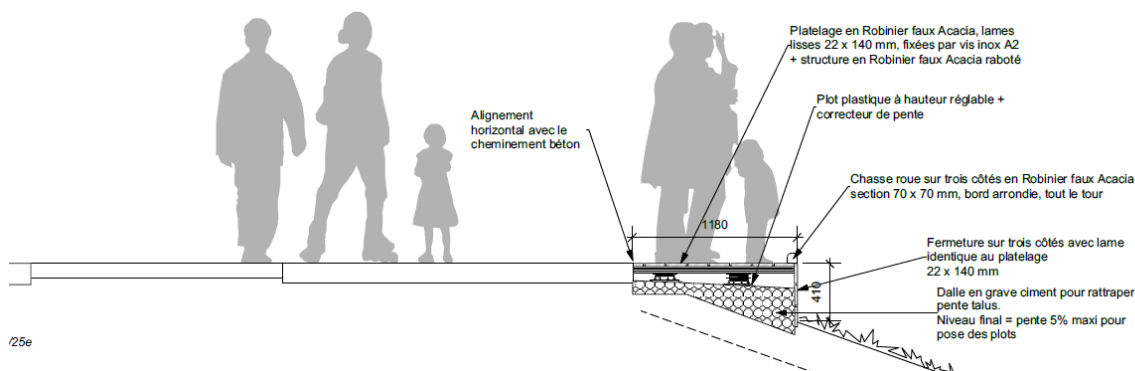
Vue en coupe sur ponton en bordure de cheminement principal.
